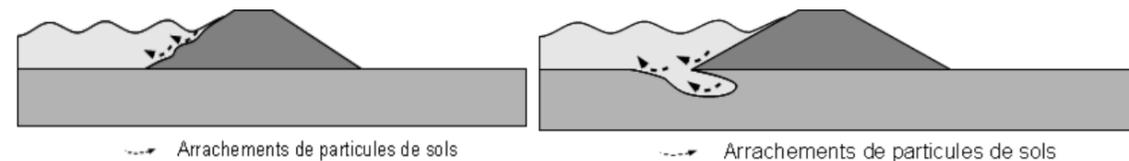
Érosion externe du corps ou de la fondation d'une digue en terre (affouillements) côté eau
